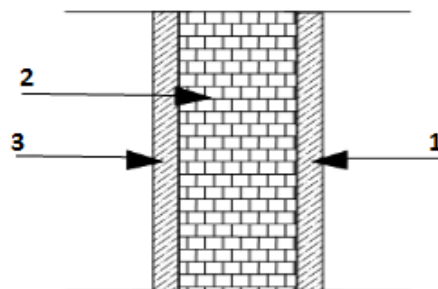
Coupe transversale du mur en simple cloison
